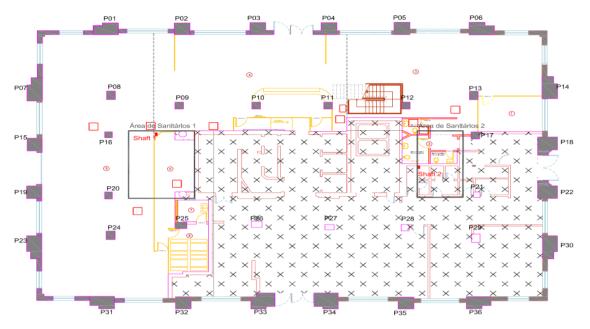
Planta do térreo – Reforma parcial da área sem hachura com área com 541,01 m²
